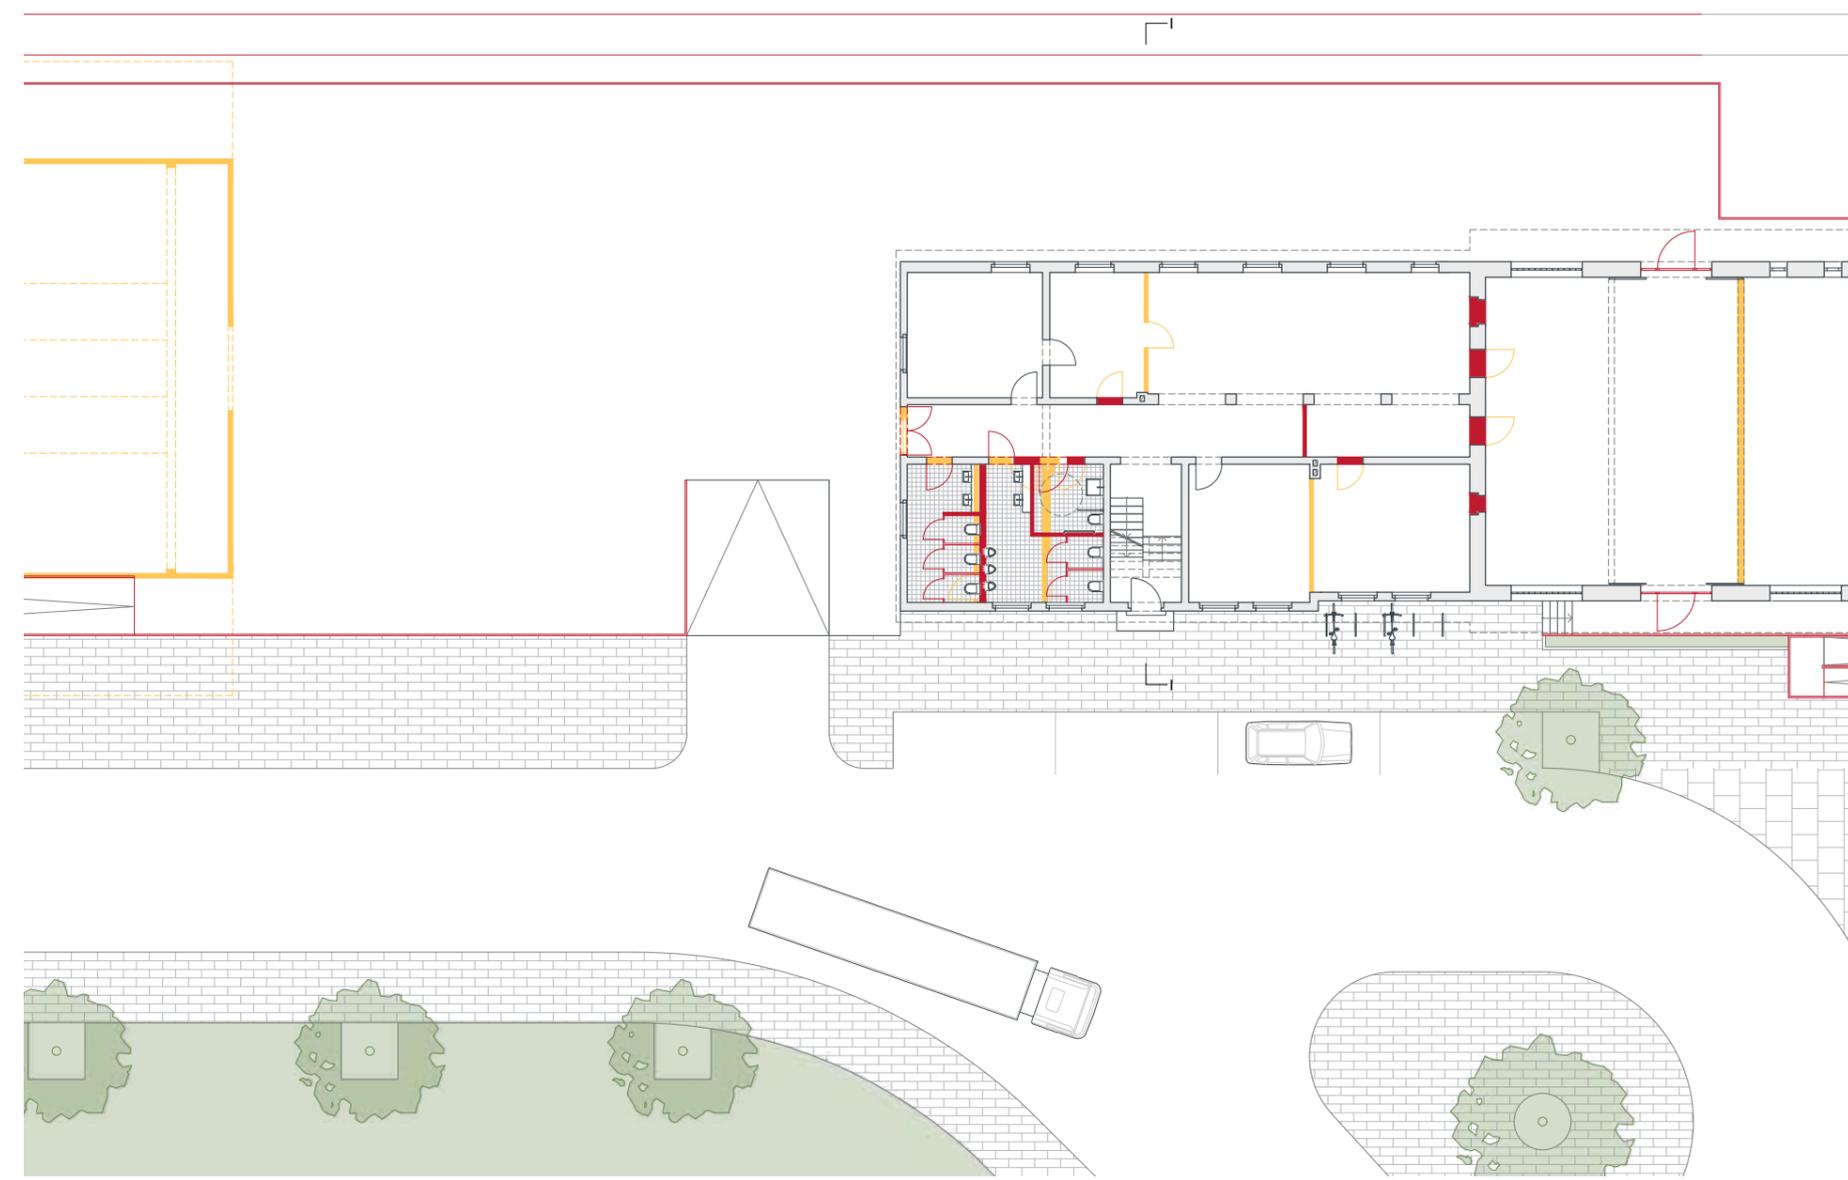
Zollamt: Bauliche Veränderungen, Bürofläche, Erdgeschoss M 1:250
